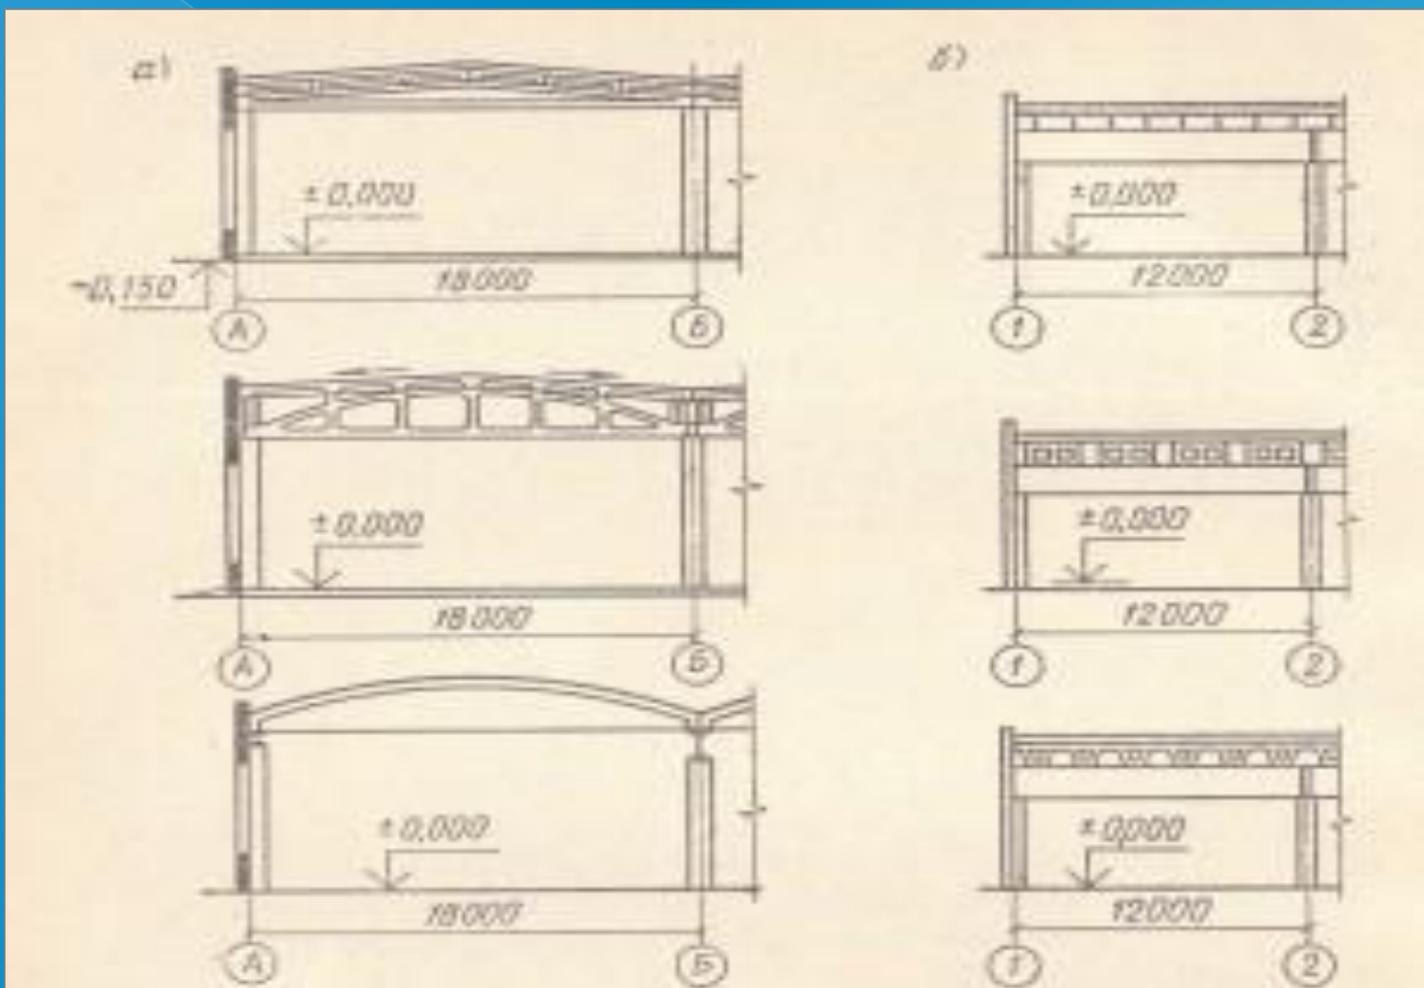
Сборные железобетонные каркасы одноэтажных производственных зданий со скатными (а) и плоскими (б) покрытиями при пролетах 18 и 12 м
